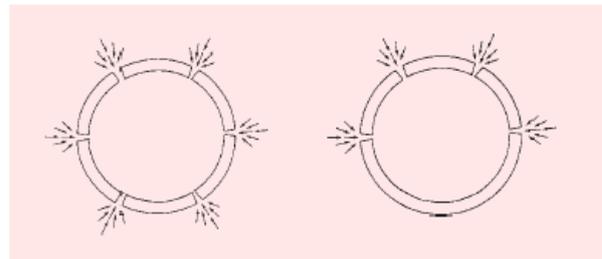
Fessurazione standard POLIDREN e DRENOSEWER 360° - DRENOSEWER a 220°
